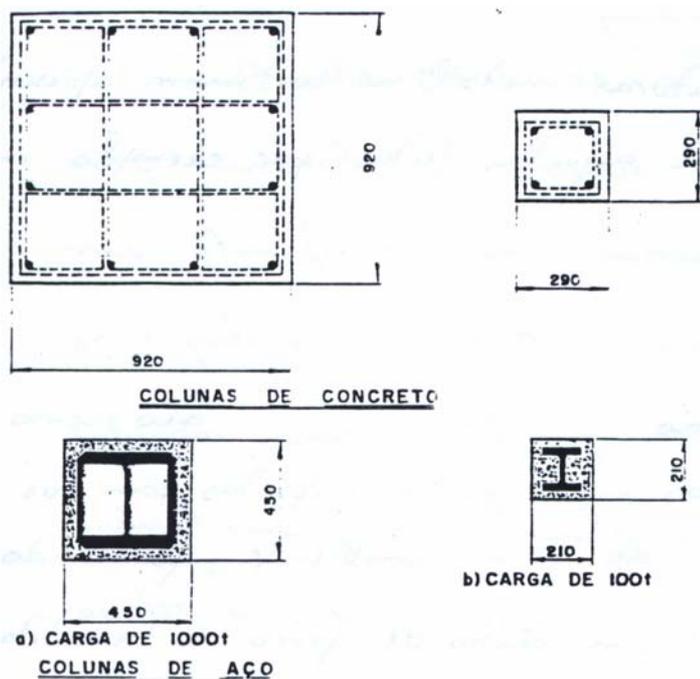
Comparação entre colunas de concreto e de aço para cargas de 100 e 1000 t.
